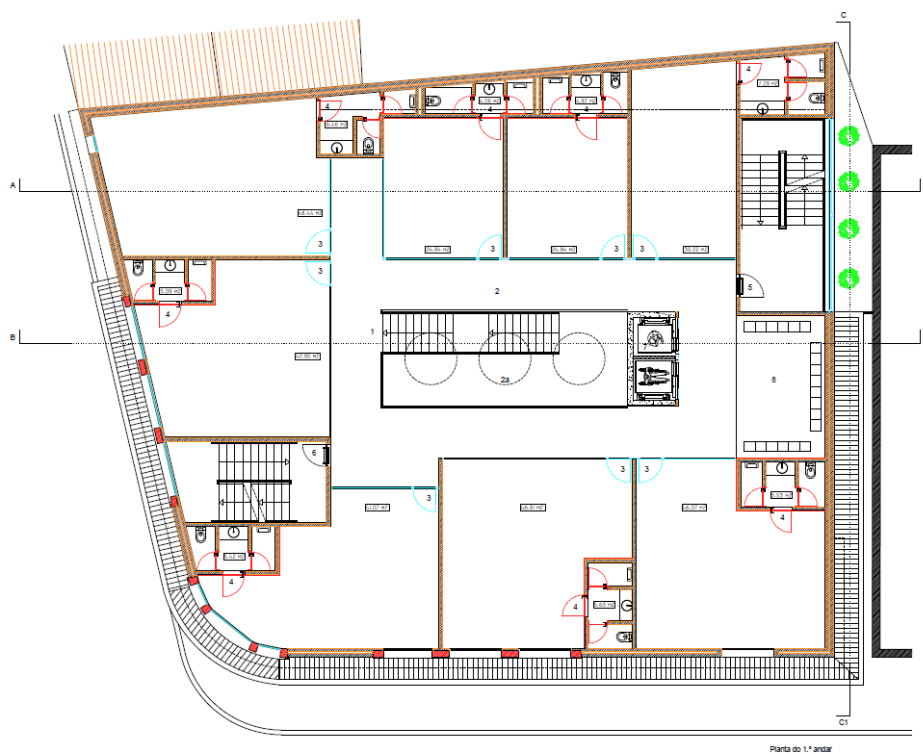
Planta do primeiro andar. Fonte: Corcovado Construções.
